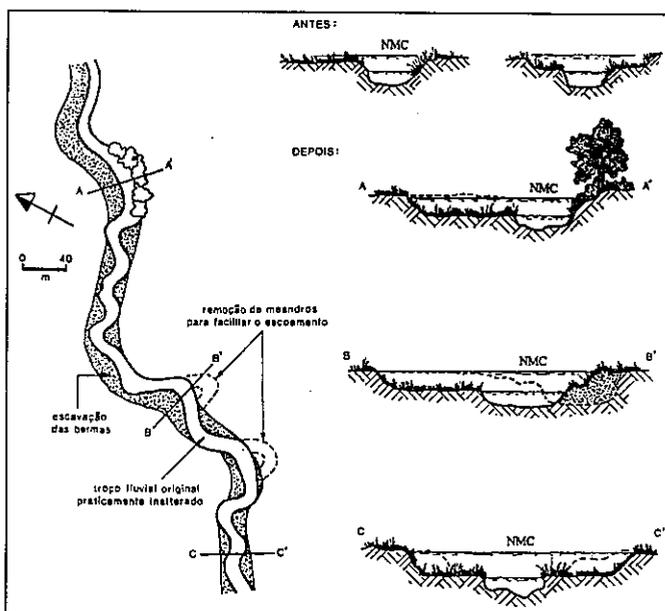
Plano longitudinal e cortes transversais de canais de secção composta (adapt. Lewis e Williams, 1984).
